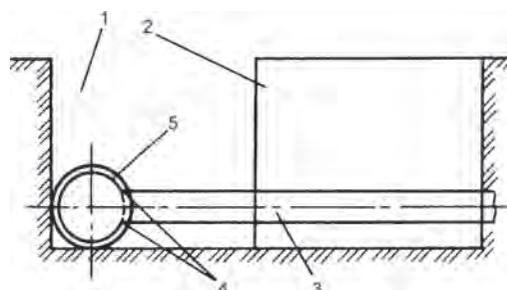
Схема соединения оросительного и увлажнительного трубопроводов:
